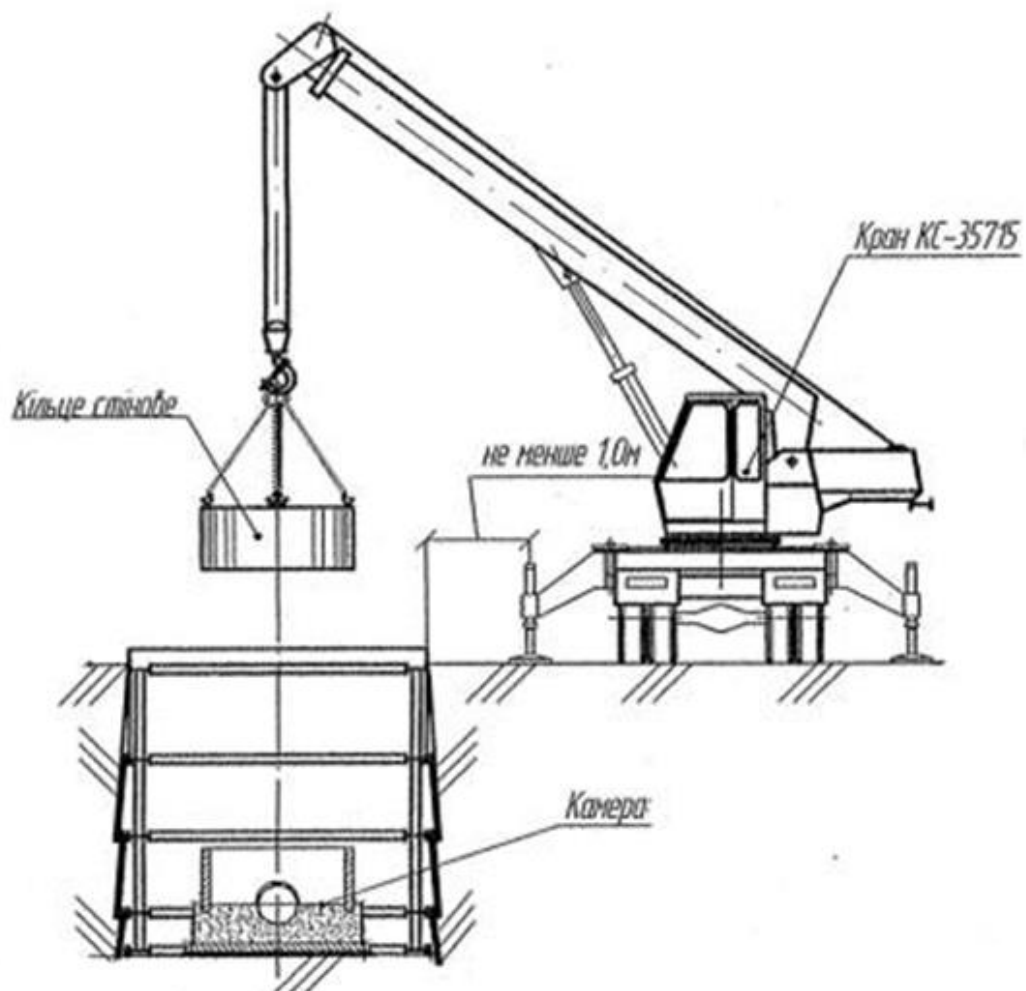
Схема монтажу залізобетонних колодязів.
